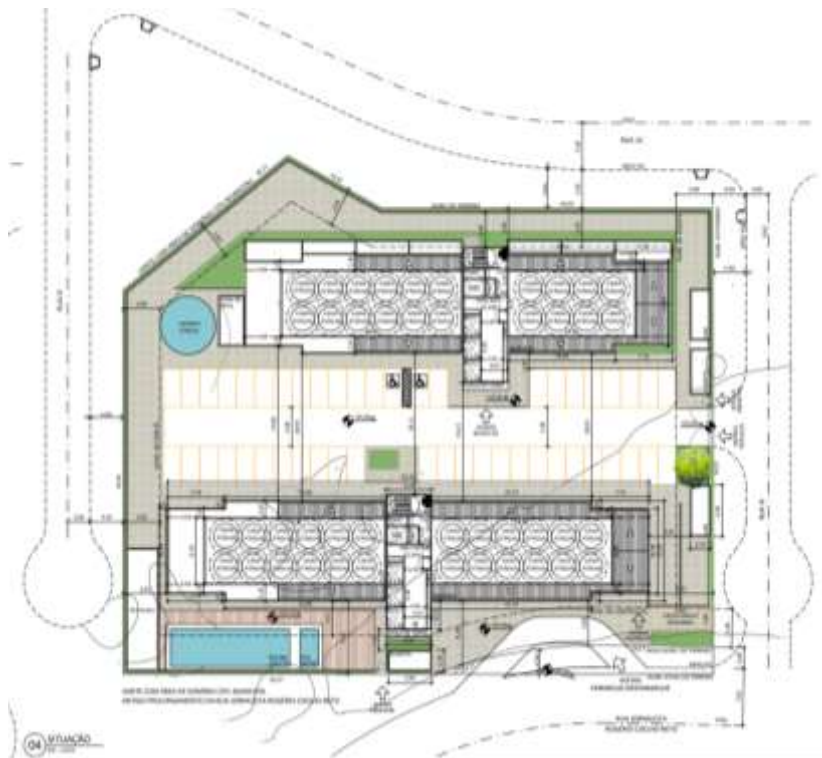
Planta de localização, Projeto legal SMU/PMN.
